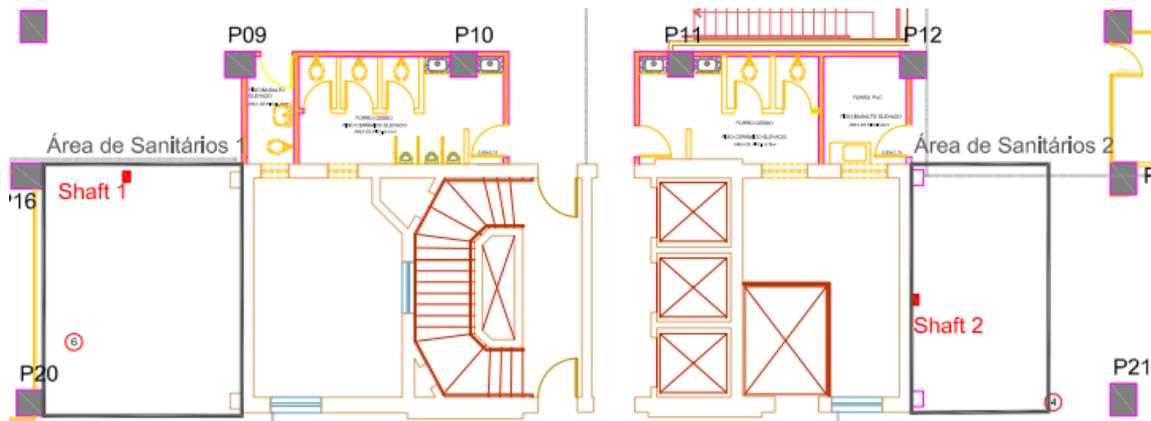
Primeiro Pavimento – Localização da área dos sanitários existentes diferentes da área dos sanitários existentes nos 3º e 2º pavimento
